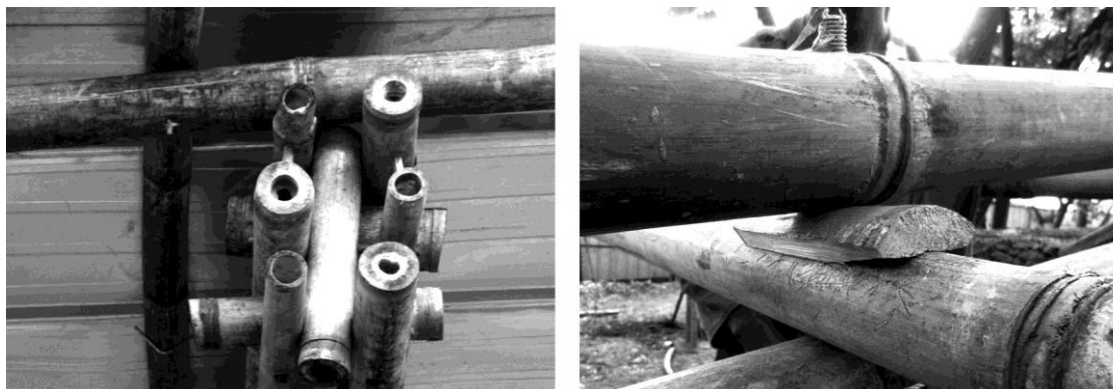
Maßabweichungen der Halmquerschnitte führen zur Schrägstellung (links). Das dünne Ende eines Halmes wurde mit einem Reststück aufgefüllert, um die Zangenkonstruktion zu füllen (rechts).
